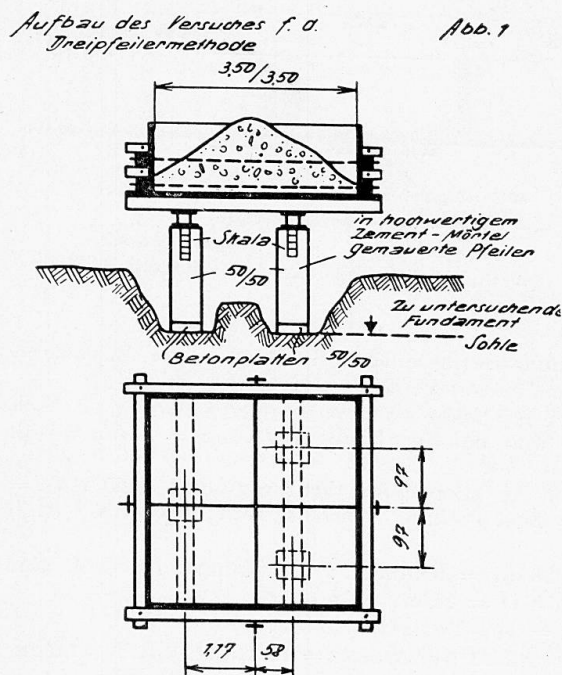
Montage du dispositif d'essai par la méthode des trois poteaux = Aufbau des Versuches f. die Dreipfeilermethode = Test arrangement for the three-pillar method. — Échelle = Skala = Scale. — Semelles de béton = Betonplatten = Concrete slabs. — Poteaux maçonnés au mortier de ciment à haute résistance = In hochwertigem Zement-Mörtel gemauerte Pfeiler = Pillars encased in high-grade cement mortar. — Sol de fondation à essayer = Zu untersuchende Fundament Sohle = Foundation soil to be tested.
